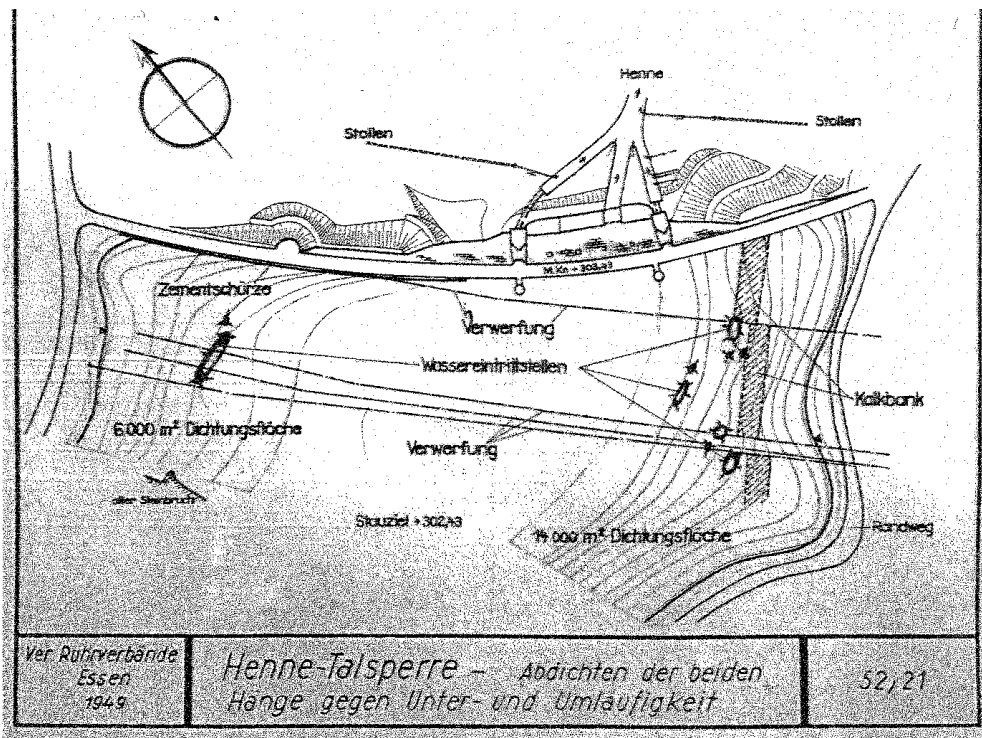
Planung aus dem Jahre 1949 zur Untergrundabdichtung an der Hennestaumauer
